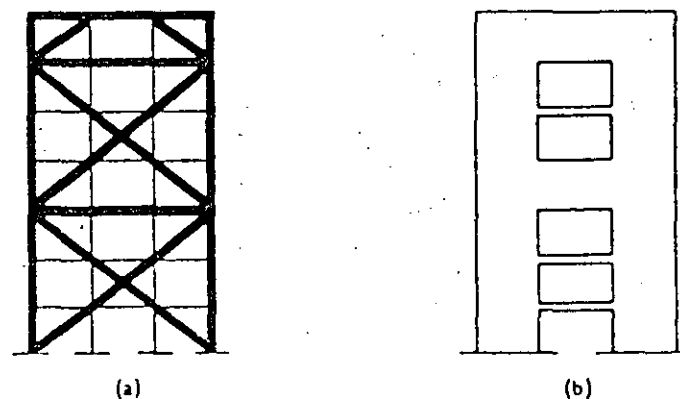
Uso eficiente de elementos rigidizantes. a) Contraventeo en cruz, b) muros de cortante y vigas de acoplamiento.
